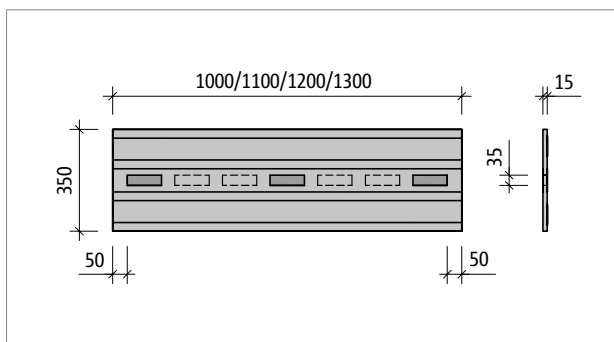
Schöck Tronsole® tip B + tip D: detajl A
